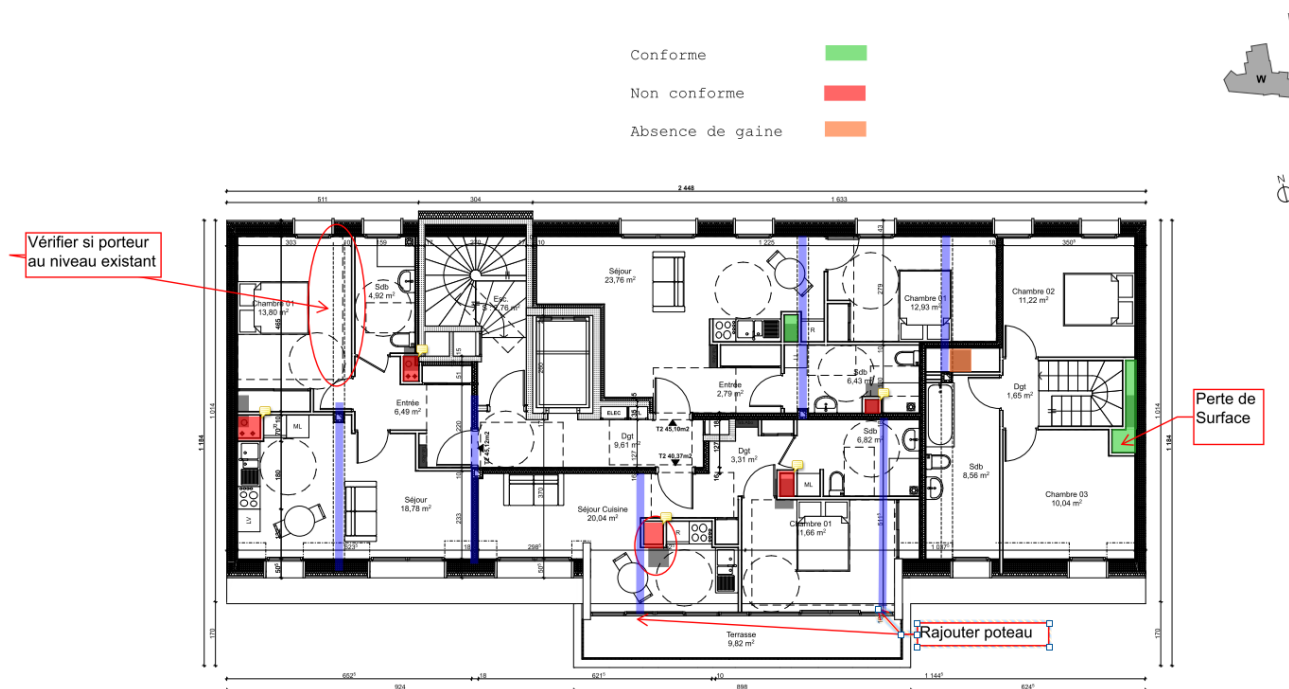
Plan Audit R+10 bâtiments Z3 surélévations. Réalisé par l'auteur avec les plans APS
